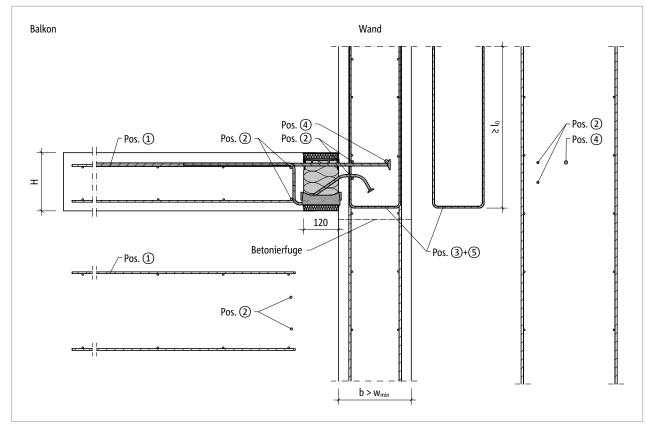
Schöck Isokorb® XT Typ K-U: Bauseitige Bewehrung für Wandanschluss nach oben mit größerer Bauteilabmessung (w<sub>vorh</sub> > w<sub>min</sub>)
